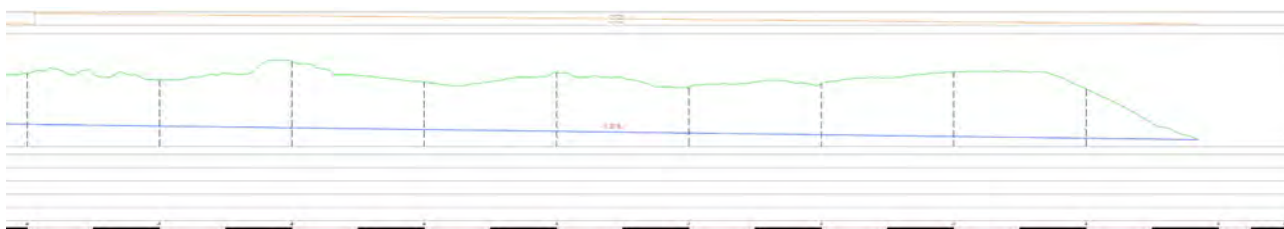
Parte 2 del profilo altimetrico d'asse dell'orizzontamento inferiore della galleria drenante.
